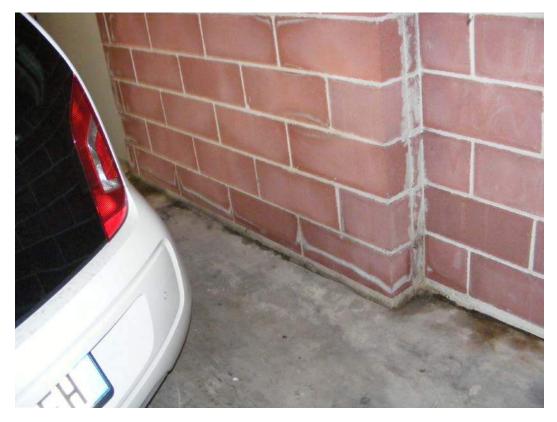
Le infiltrazioni dovute al pozzetto, al piede della parete
